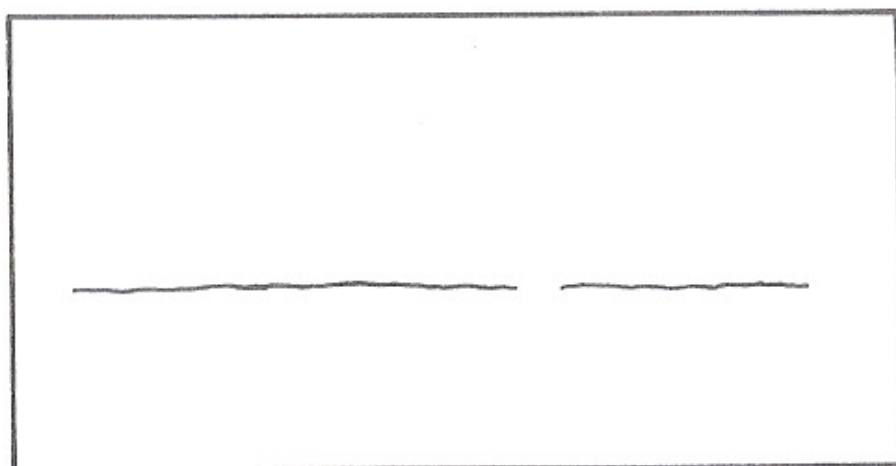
fissuras horizontais na alvenaria (THOMAZ, 1989, p. 64)
